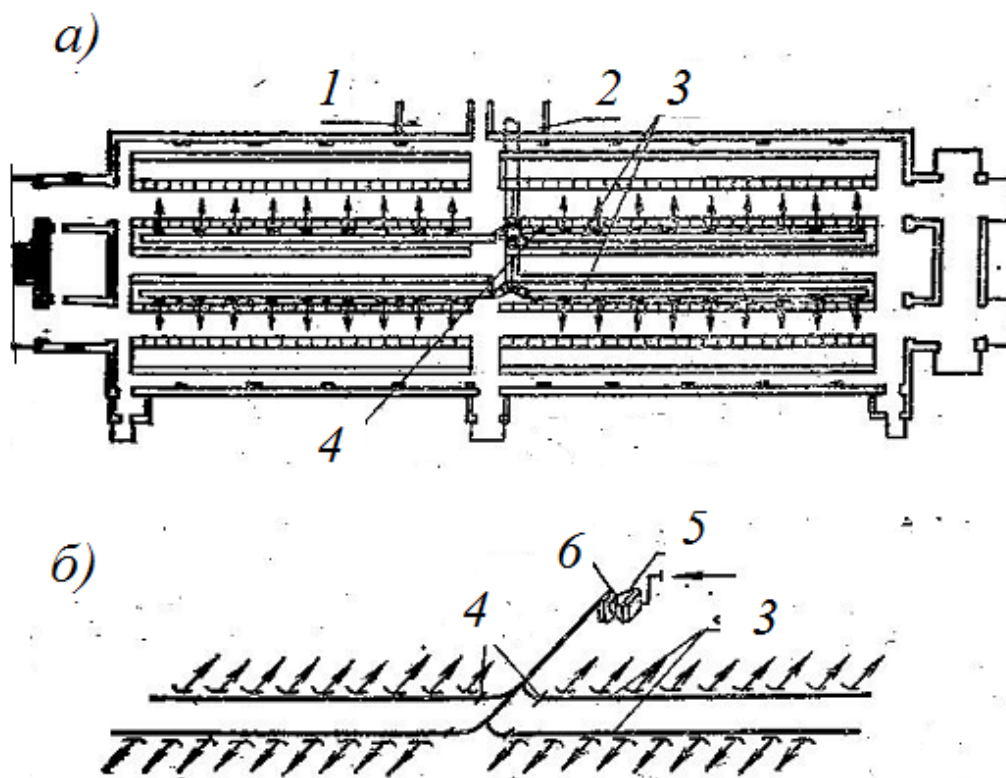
План (а) и схема устройства (б) приточной вентиляционной системы в четырехрядном коровнике: 1- пристройка; 2 - приточная камера; 3 - пирамидальный воздуховод; 4 -дрессель-клапаны; 5 - калориферы; 6 - центробежный вентилятор
